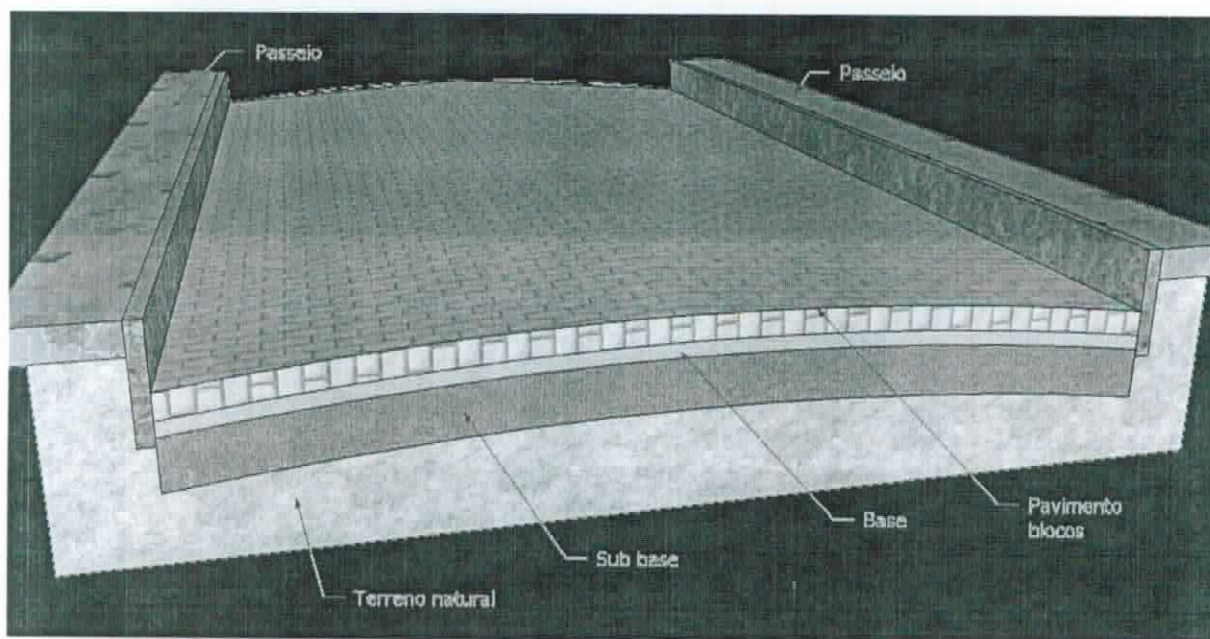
Desenho esquemático do perfil transversal da pavimentação.
